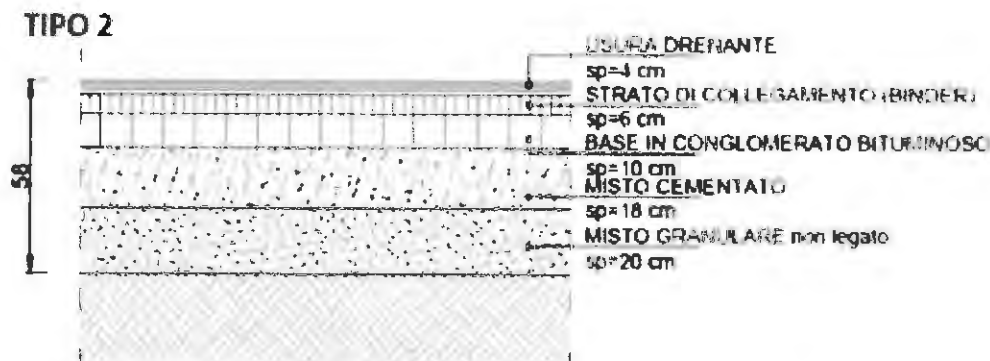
Sezione TIPO 2 progetto esecutivo – Rampe Svincolo Sud
